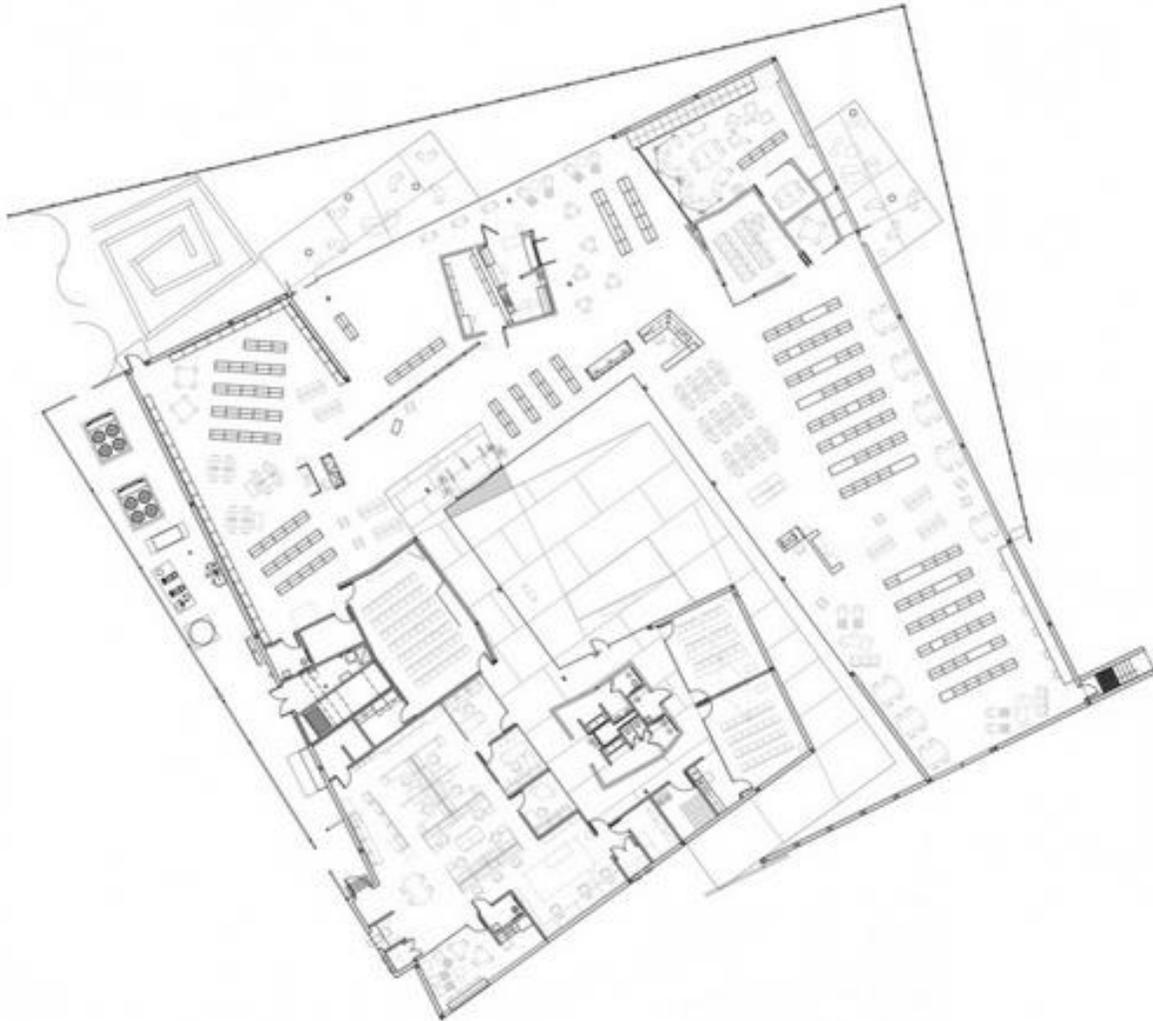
Planta Arquitectónica (amueblada). Planta Alta. Imagen extraída de Arch Daily
